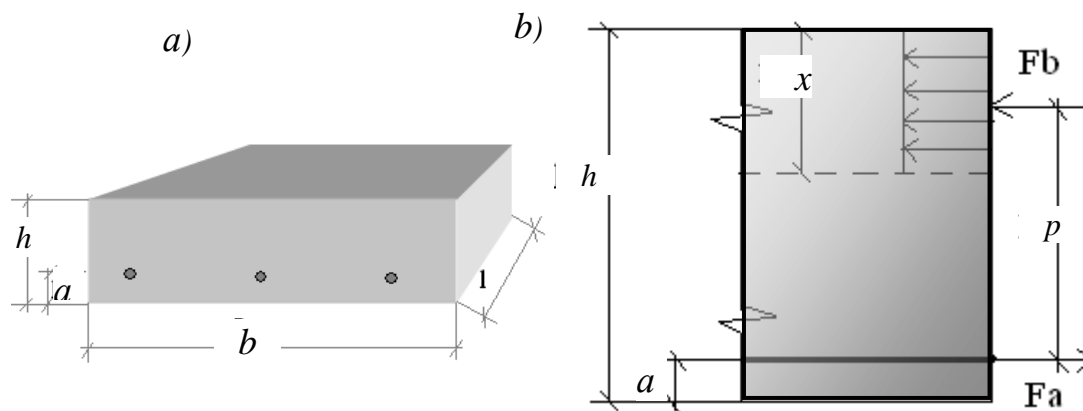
Общий вид (а) и расчётная схема (б) железобетонной затяжки
